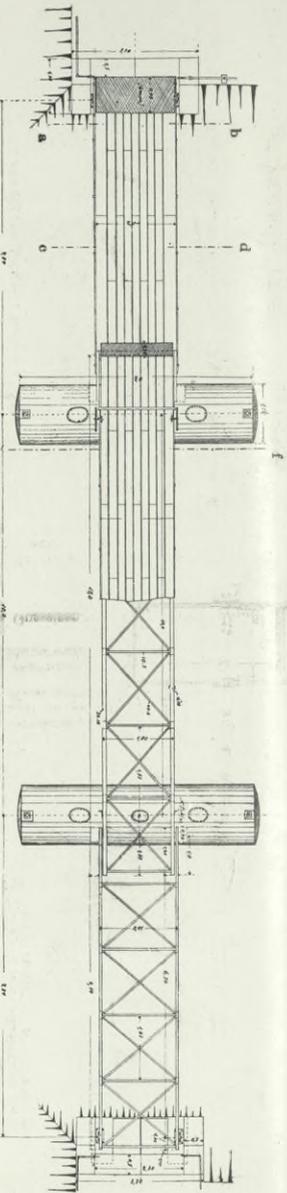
Grundriss bei einem Wasserstand 67,80 m.
